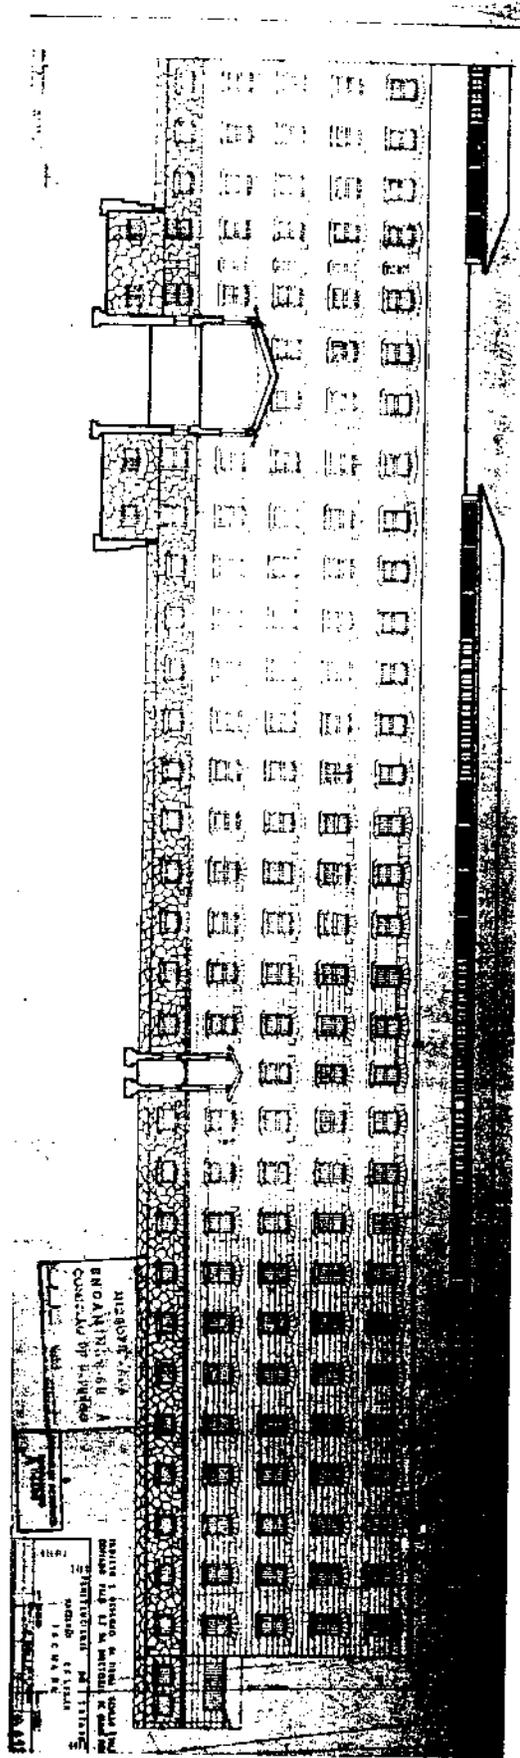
Desenho da fachada do Pavilhão celular da Penitenciária do Estado
